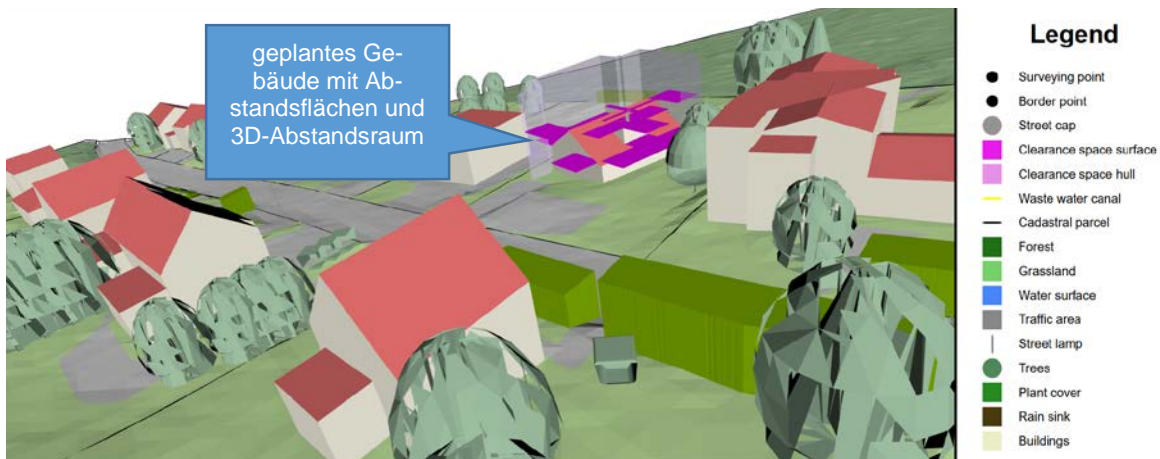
Beispiel 3D-Lageplan zum Baugesuch (MÜLLER 2021)
